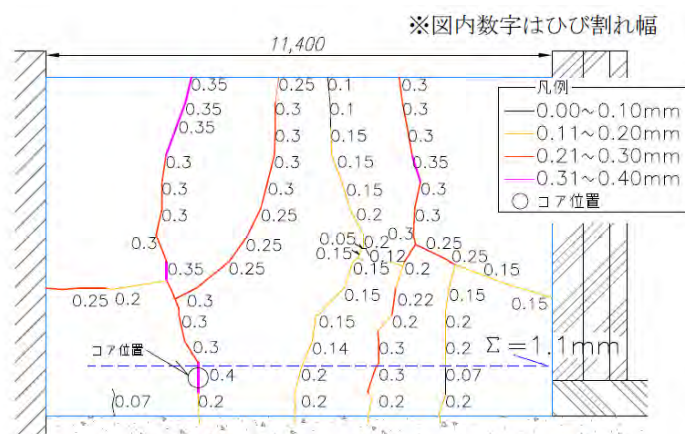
材齢 812 日における側部低拡散材（LP45 配合）のひび割れ状況（側面図）
